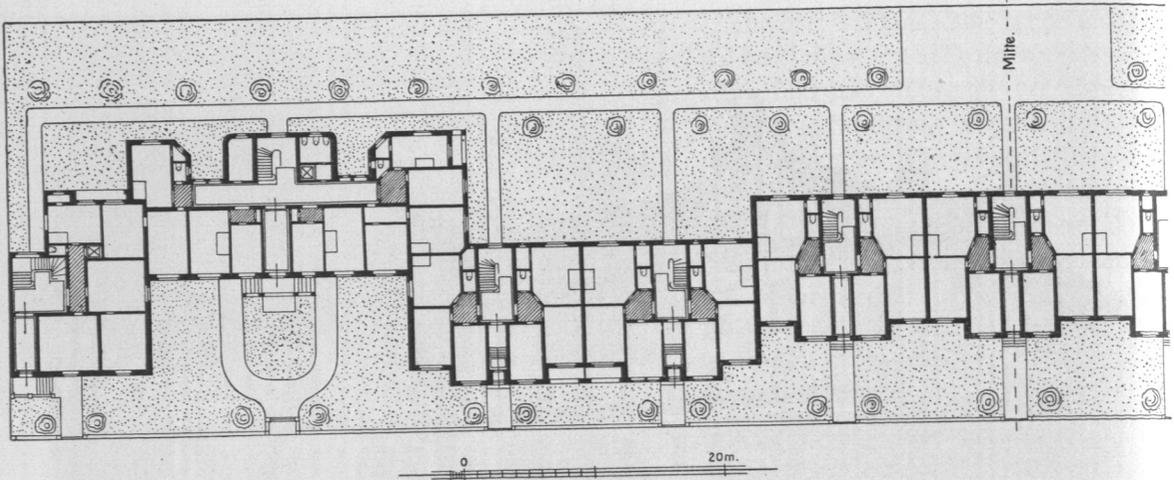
Julius- und Betty-Rée-Stift, Erdgeschoß, Grundriß.
